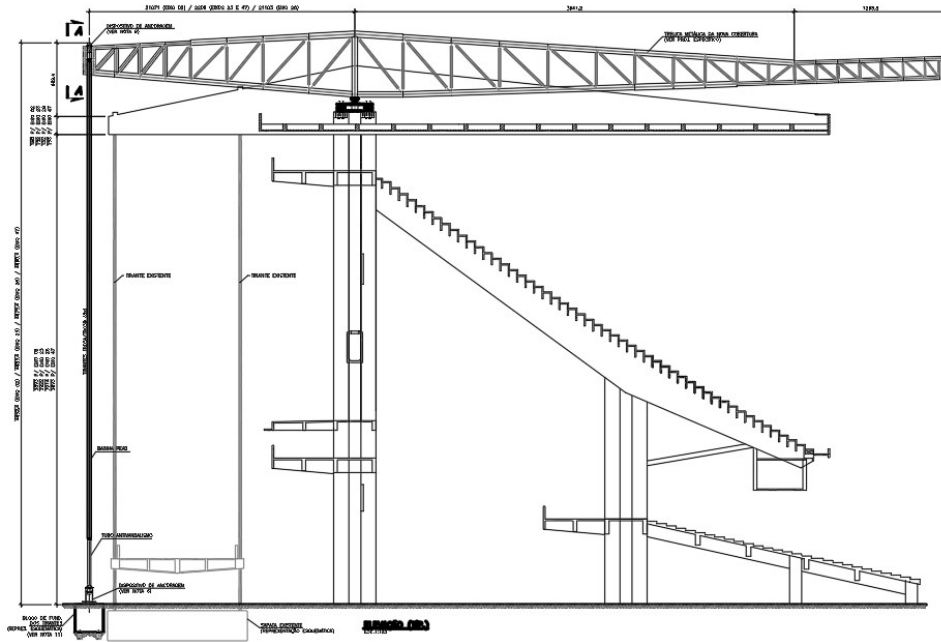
Elevação das Treliças Metálicas sobre a Cobertura.
